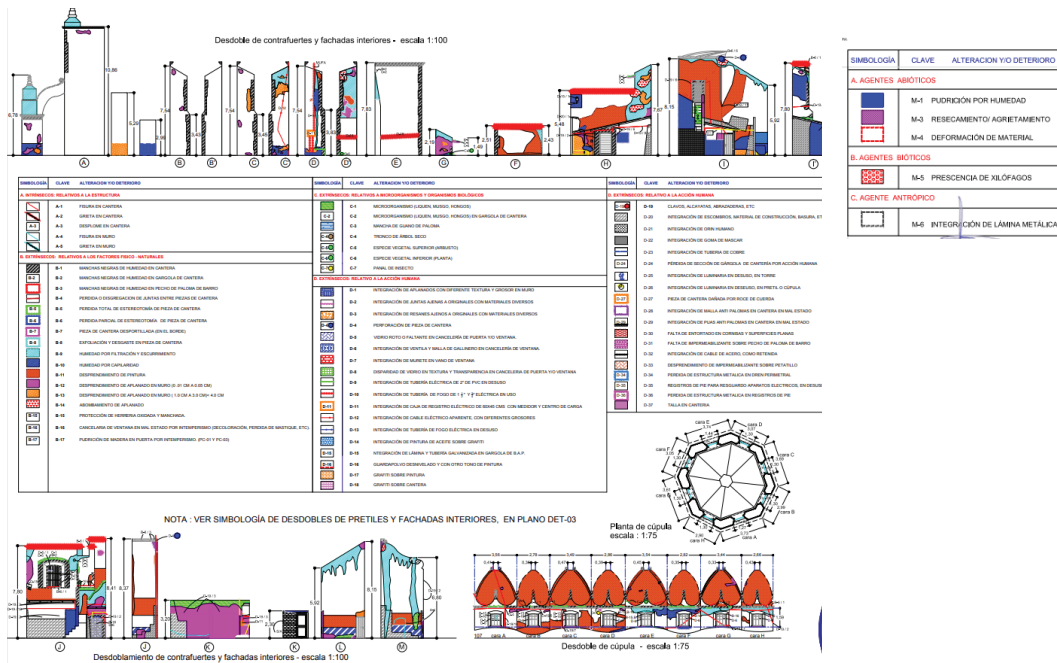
Levantamiento de deterioros. Contrafuertes, fachadas interiores y cupulas- Registro de materiales, 2017. Elaborado por: M.R.S. Arq. M. Pilar Vargas y M.R.S. Arq. Ma De La Luz Ávila H./ Image 7. Survey of deterioration. Buttresses, interior facades and cupolas- Material register, 2017. Prepared by: M.R.S. Arq. M. Pilar Vargas and M.R.S. Arq. Ma De La Luz Avila H.
